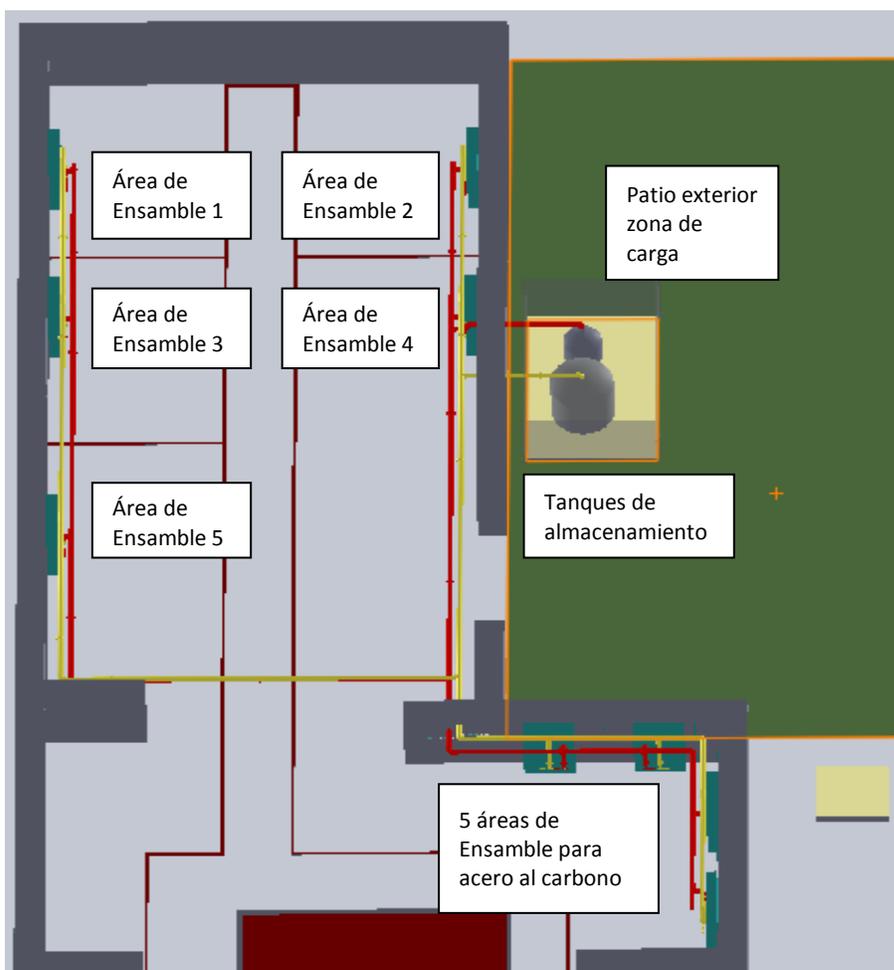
Layout de la planta, indicando las nueve estaciones de tomas de gas distribuidas en la planta de ensamble y los tanques de almacenamiento.
